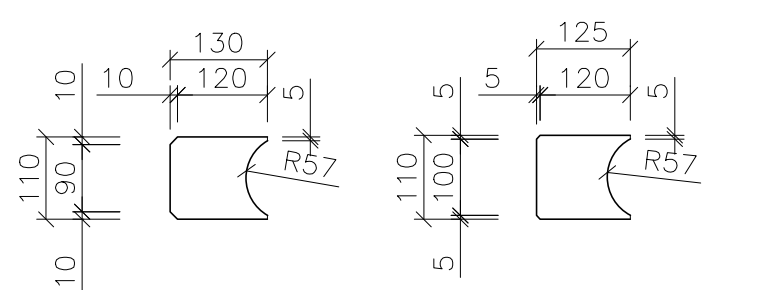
DETAIL PŘÍPOJE ZAVĚTROVÁNÍ A PODÉLNÉHO ZTUŽIDLA
